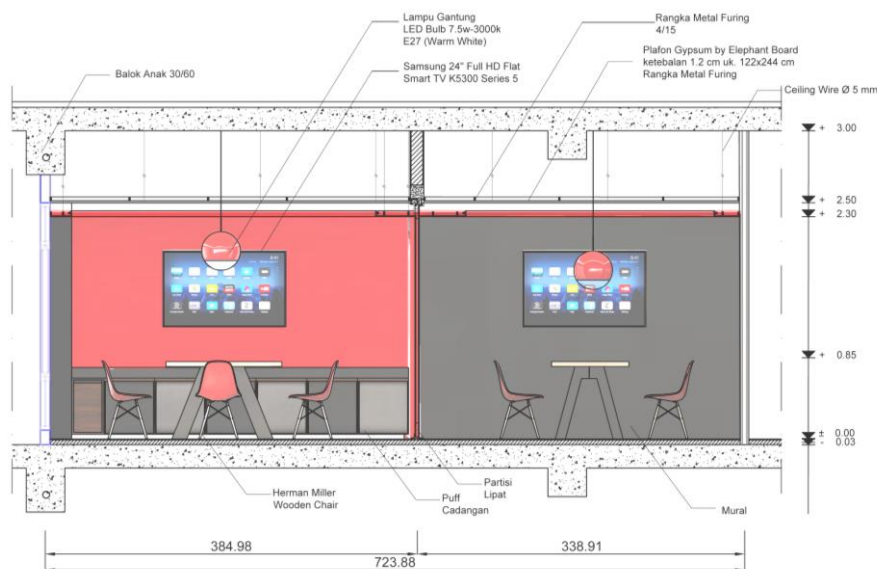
Layout Furnire Ruang Terpilih 2
